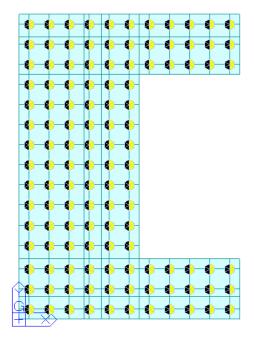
Vista 3D planimetrica del modello di calcolo Spalle
